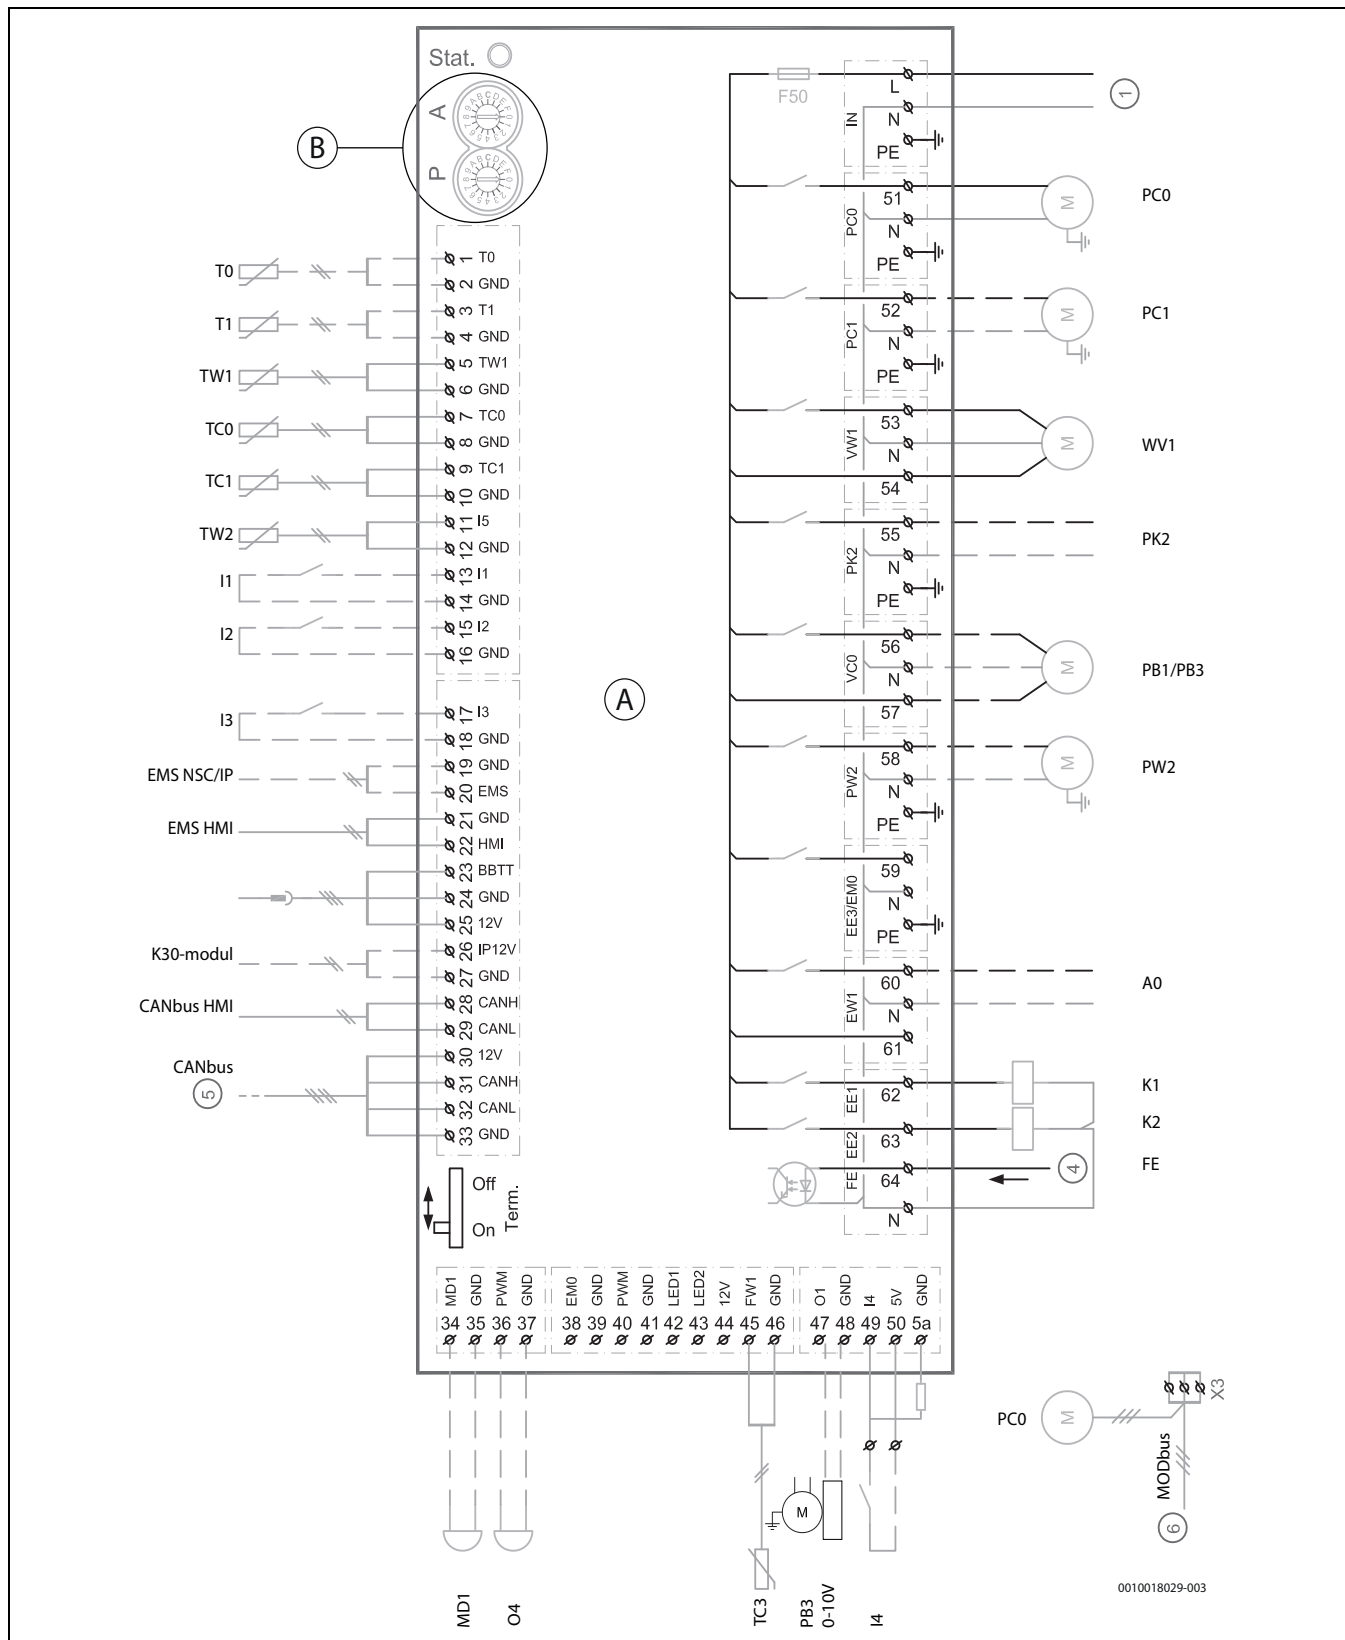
Schéma zapojení hlavního obvodu, 12–16 kW
